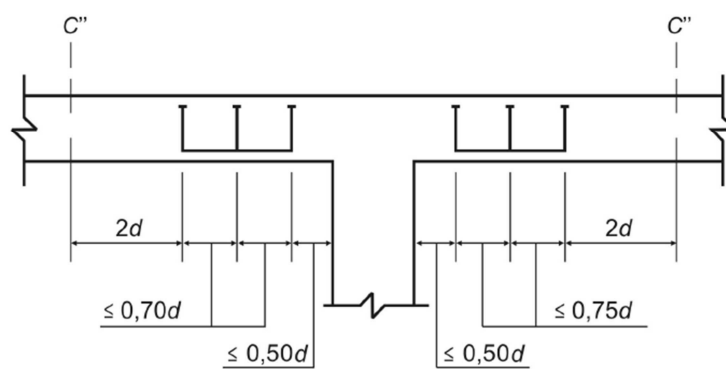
Disposição da armadura de punção (NBR 6118: 2007)
